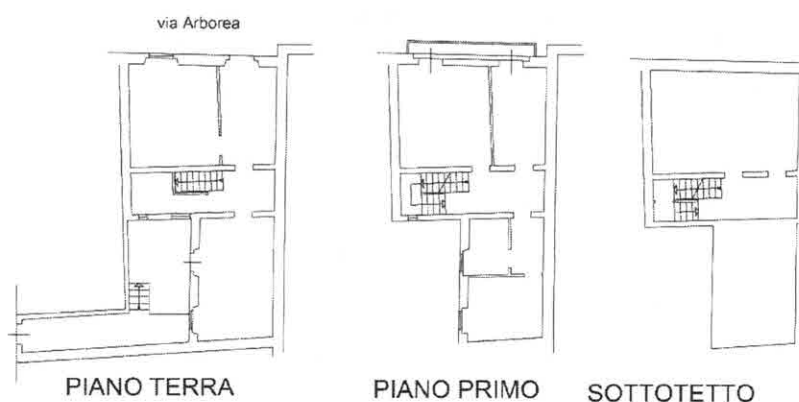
e n.2 - Stralcio scheda planimetrica del 18/01/1966
